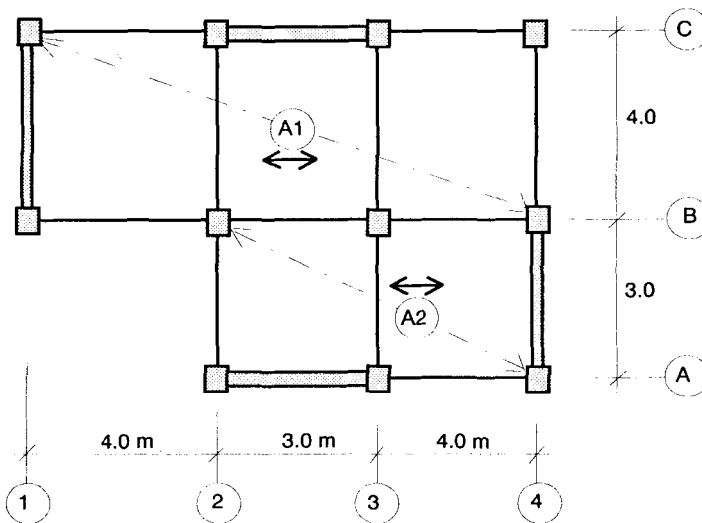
Planta Típica del Problema Propuesto No. 1.
